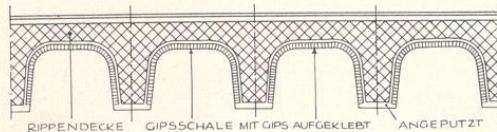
Verkleidung der Eisenbetonstegdecke mit gegossenen Gipshohlkörpern zur Isolierung und Verhütung von Rißbildungen in der Putzdecke
